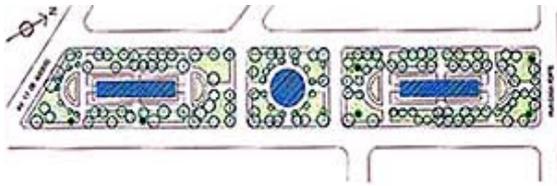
Planta baixa esquemática do Jardim de Casa Forte.
